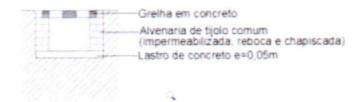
Detalhamento da vala de drenagem com tampa de concreto
